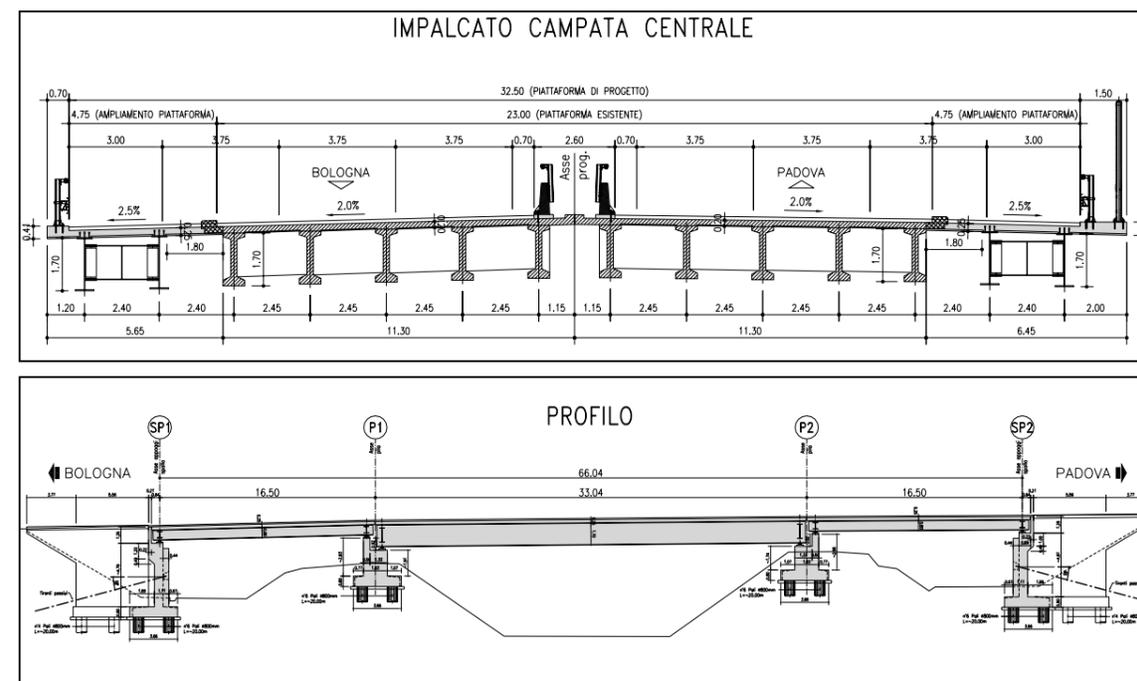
Sezione dell'impalcato e profilo del ponte sul canale Canaletta
